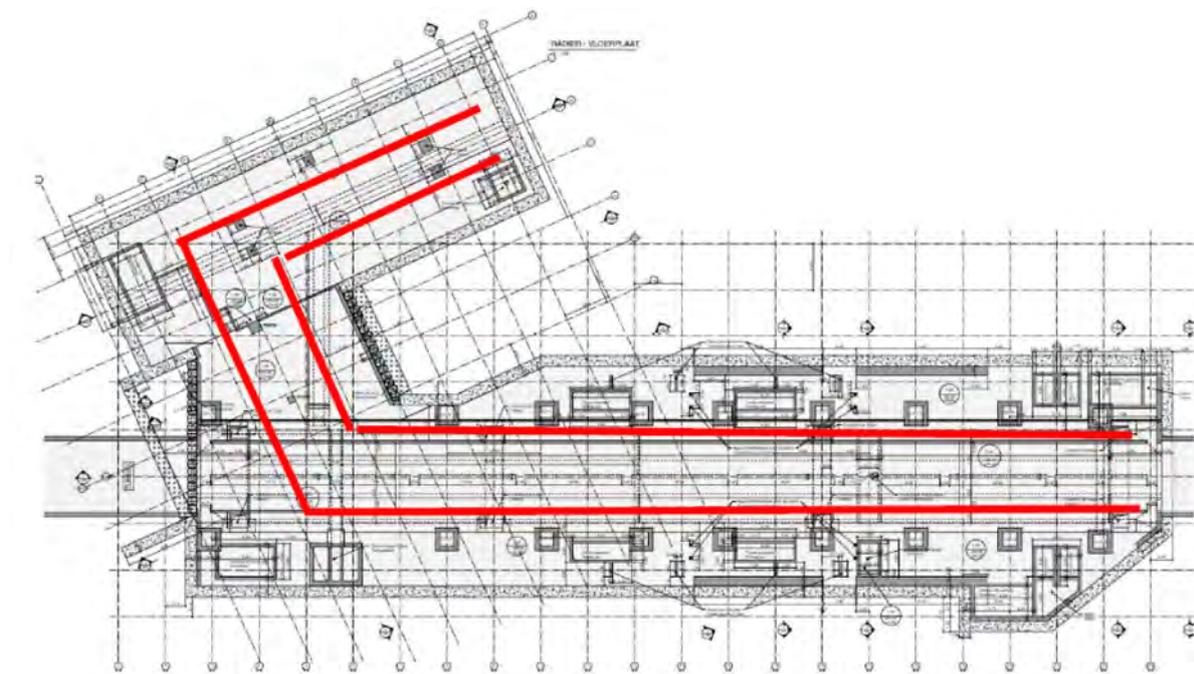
Localisation drains horizontaux (en rouge) (BMN, 2020)
